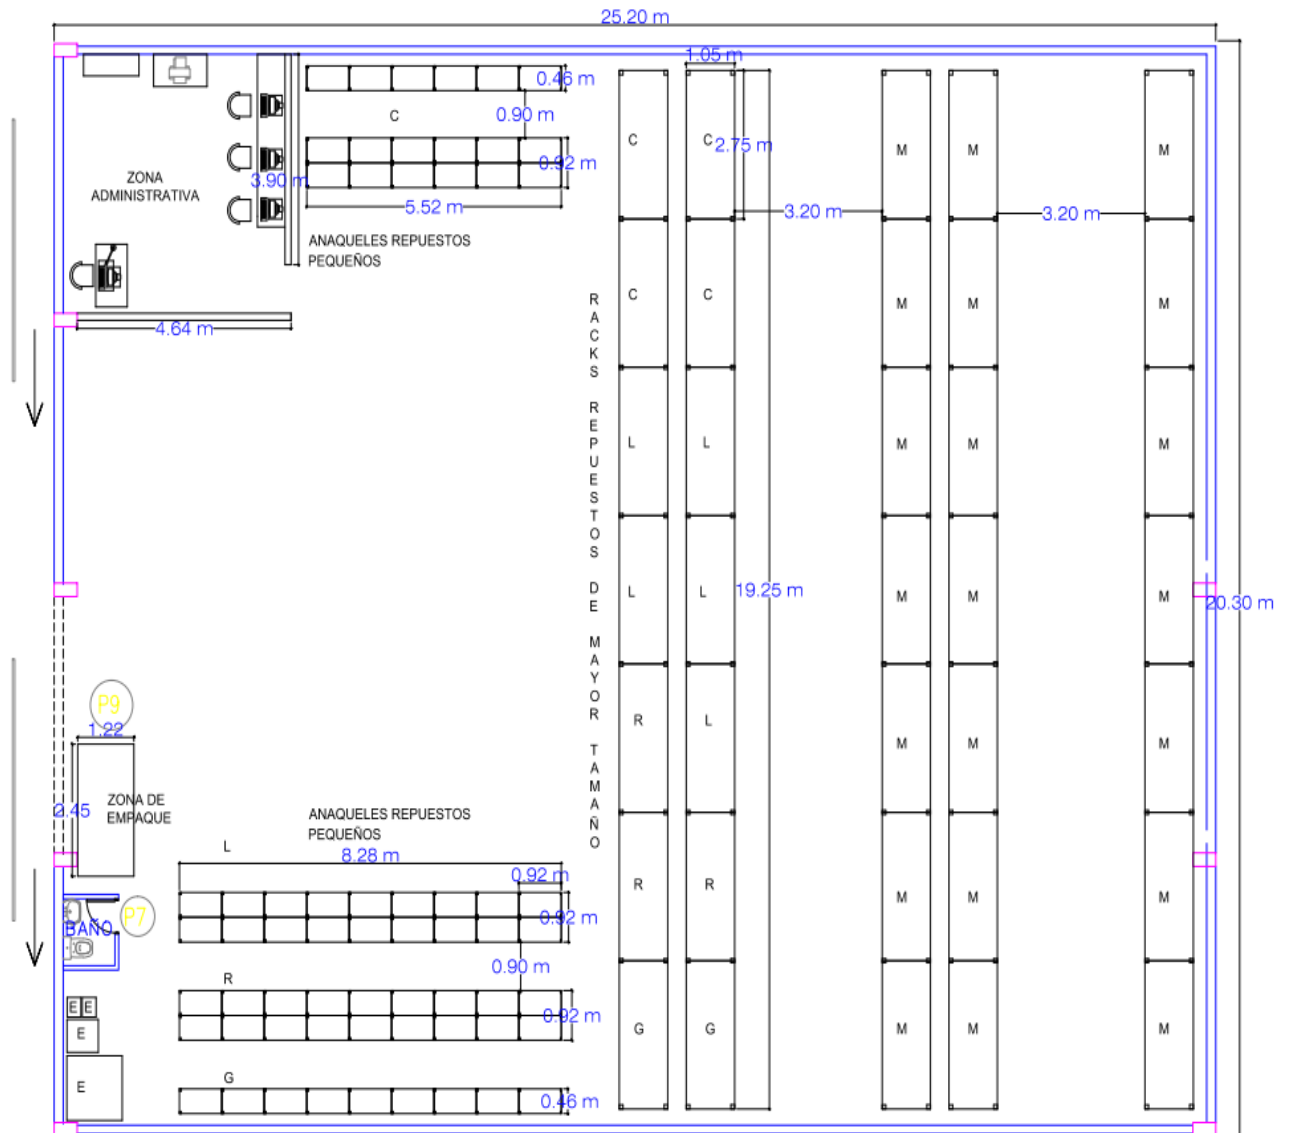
Diseño 2D – “Layout” Propuesto – Vista de Planta - Almacén de Repuestos
